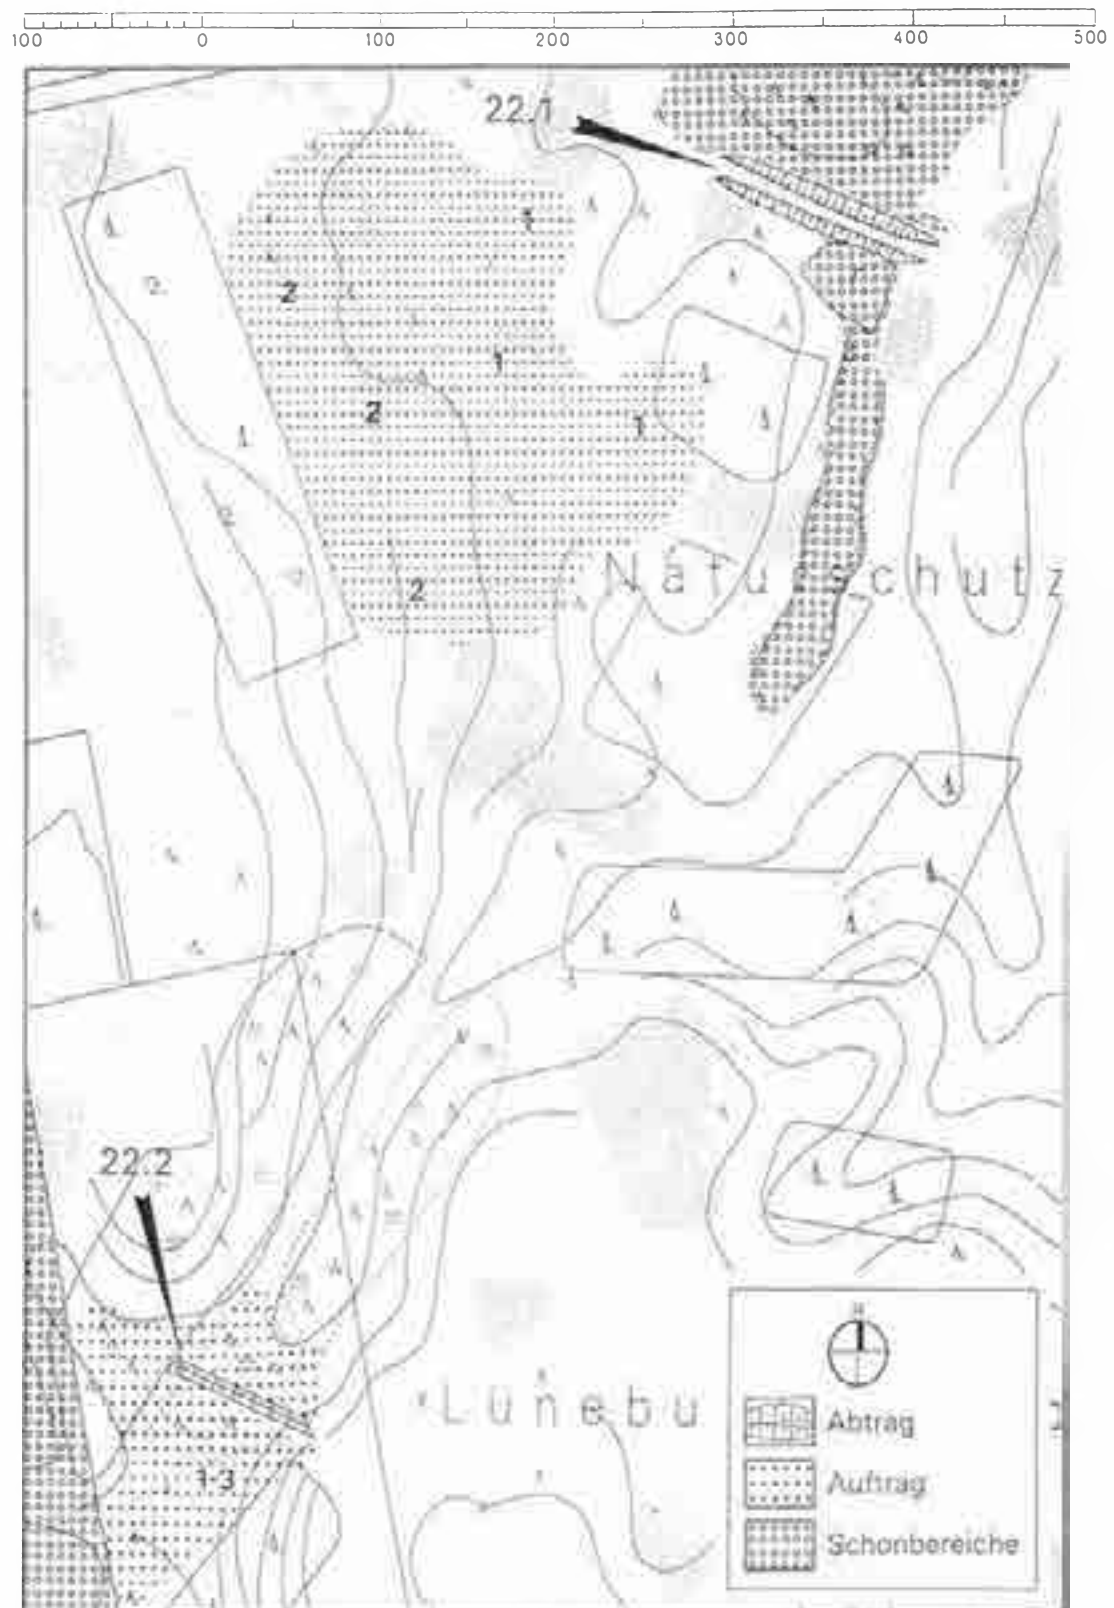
Detailplan 22.1,2. – Wallanlage mit kleinem überspannten Becken 200 m westlich vom Möhregrund; Wallanlage mit kleinem überspannten Becken im östlichen Bereich Osterheide.
